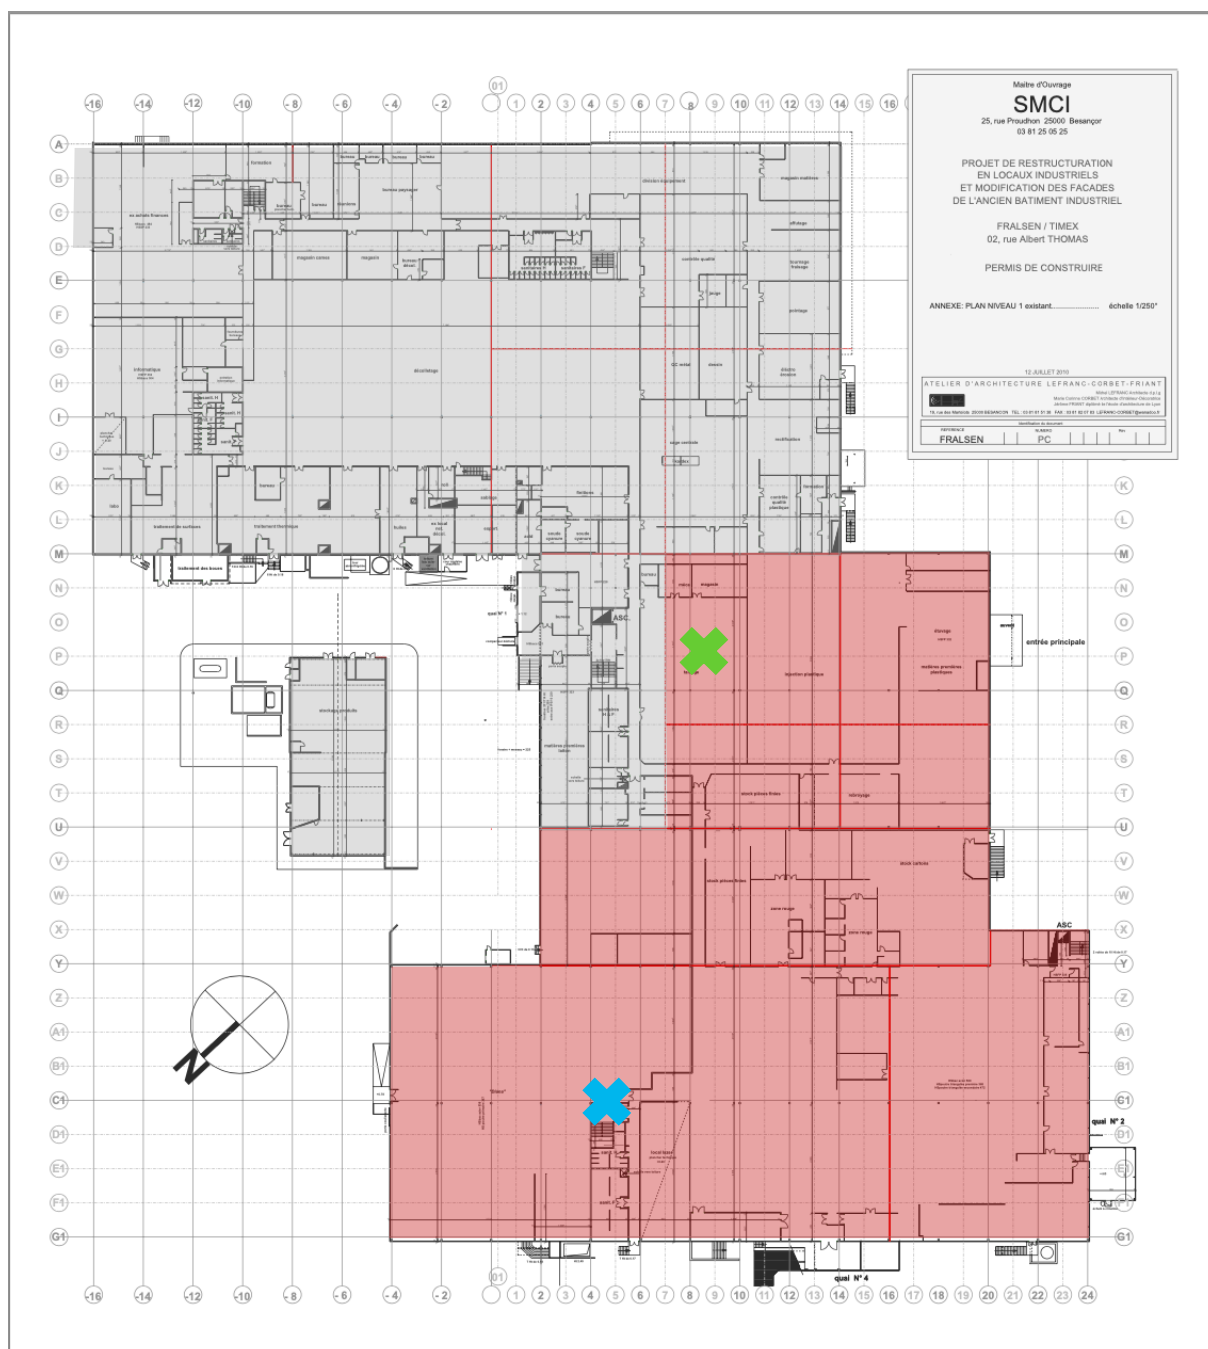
Plan du niveau 1 existant – Emplacement des prélèvements
